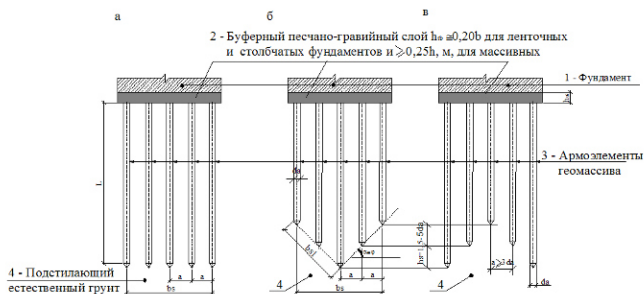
Схема вертикального армирования (геомассива) плитного массивного фундамента
